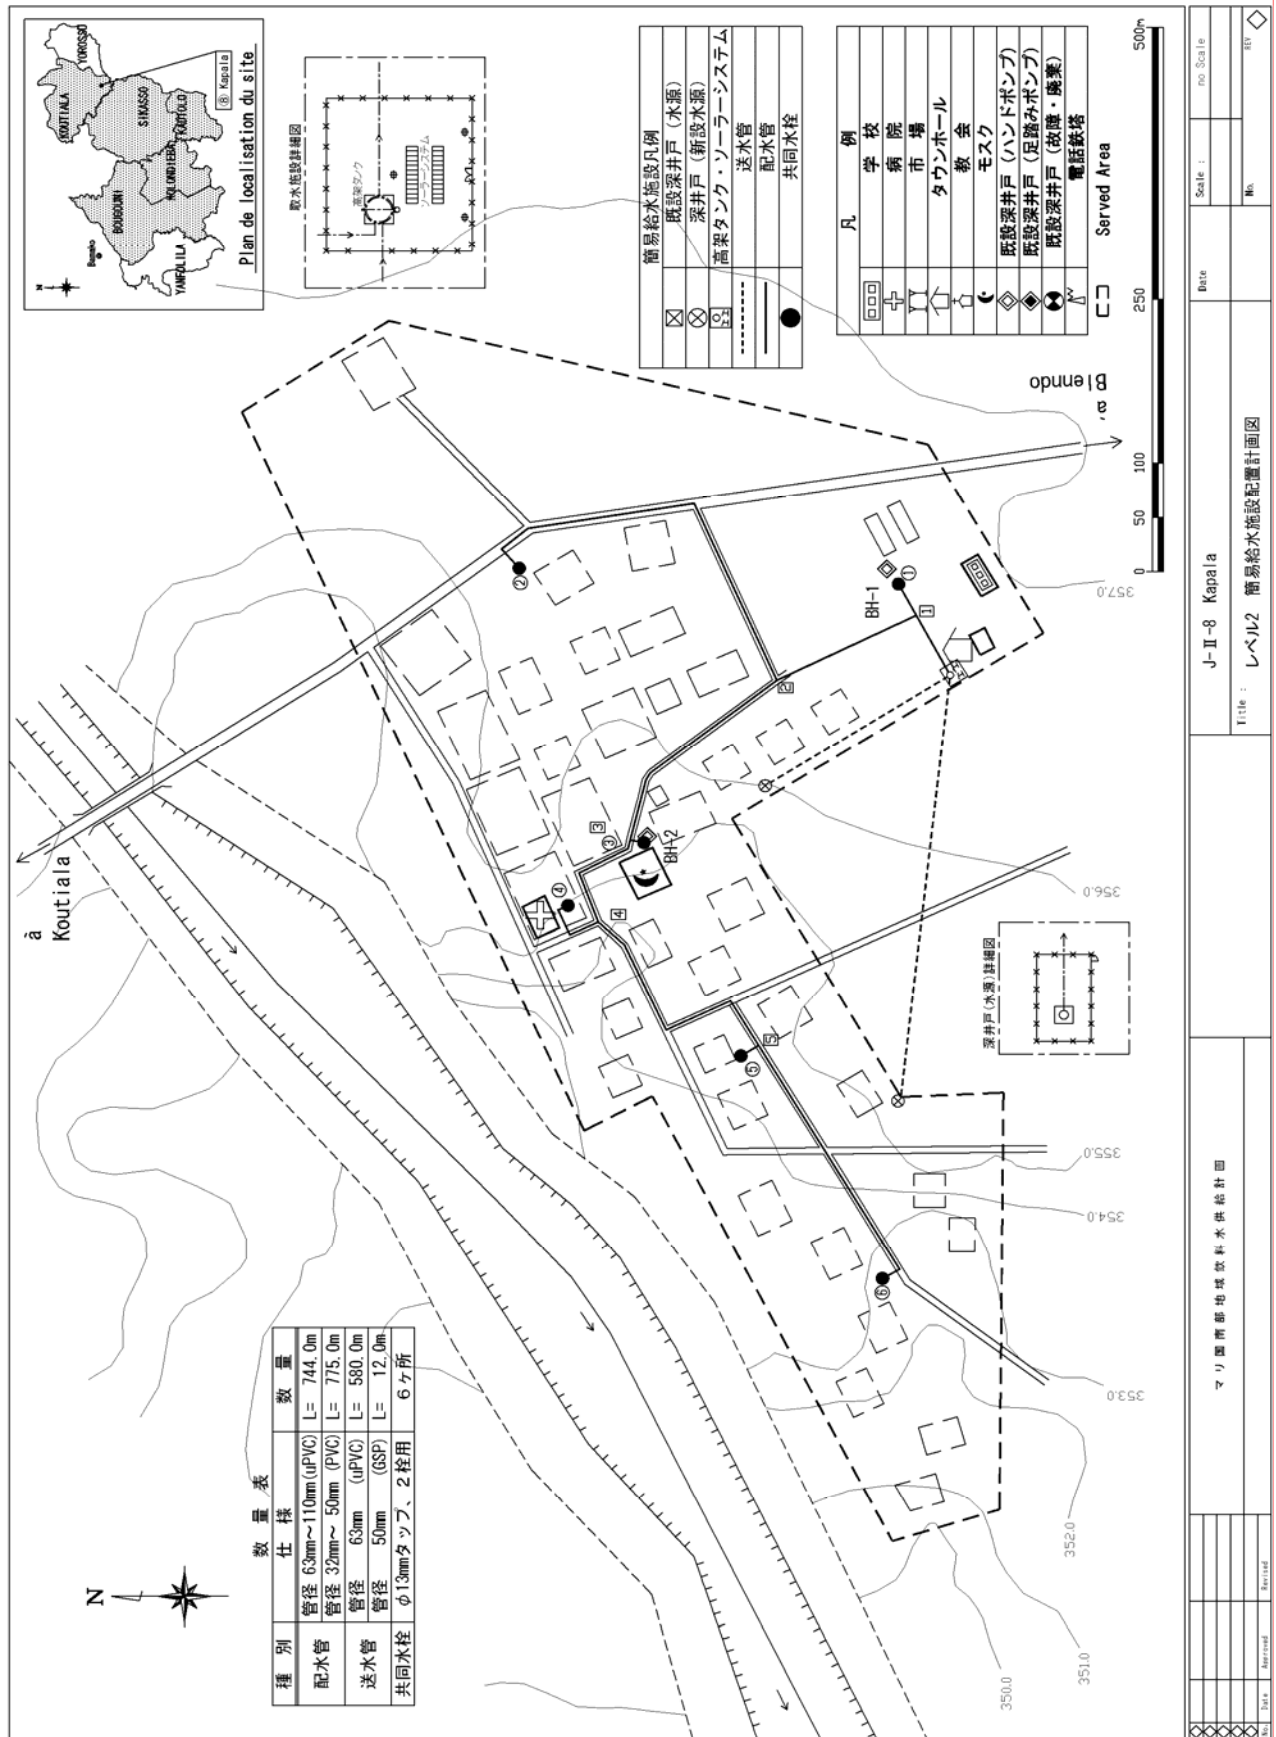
レベル 2 給水施設配置図 (J-II-8 Kapala)
